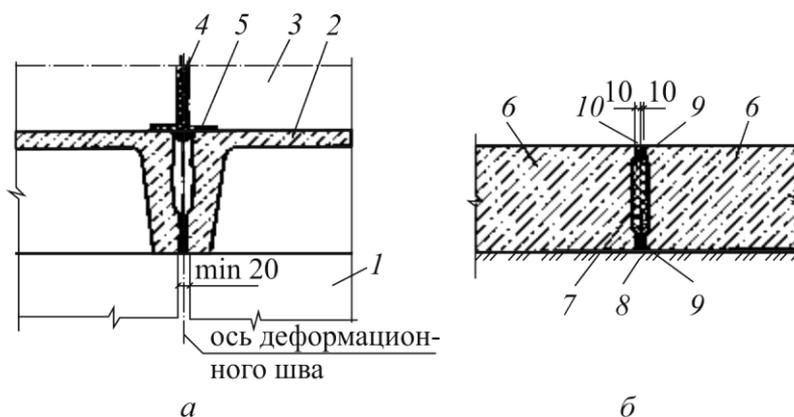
Пример решения температурно-усадочного шва: *а* – перекрытия подвала; *б* – стены подвала; 1 – ригель; 2 – панель перекрытия; 3 – пол цеха; 4 – деформационный шов в полу цеха в соответствии со СНиП II-V. 8-71; 5 – компенсатор; 6 – стеновая панель; 7 – битумная мастика; 8 – тиоколовый герметик; 9 – просмоленная пакля; 10 – цементный раствор
